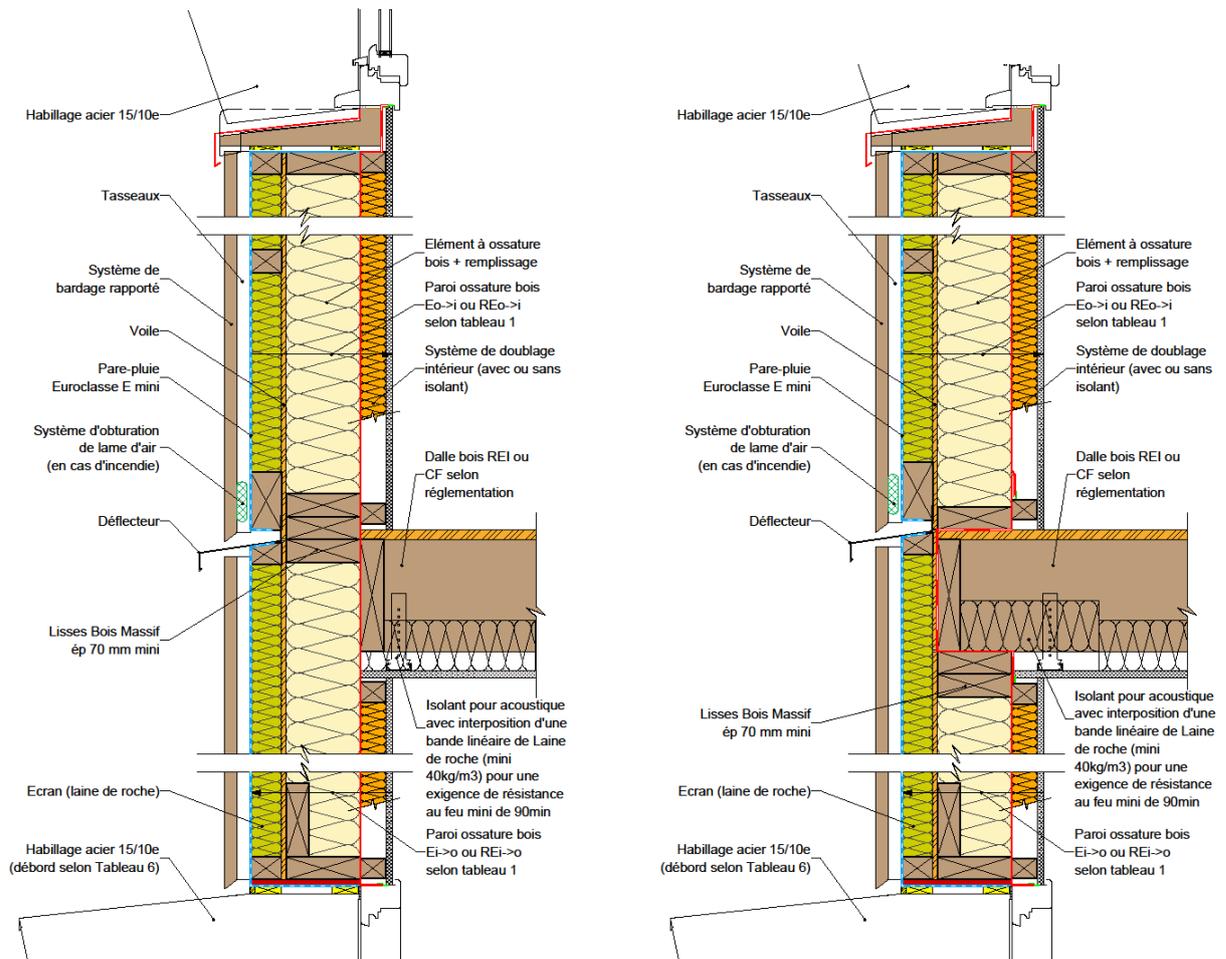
Façade/mur en ossature bois & plancher en ossature bois.
